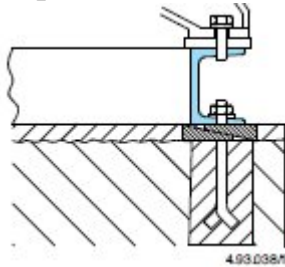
Основа для агрегату на опорній плиті зі зварного профілю.
